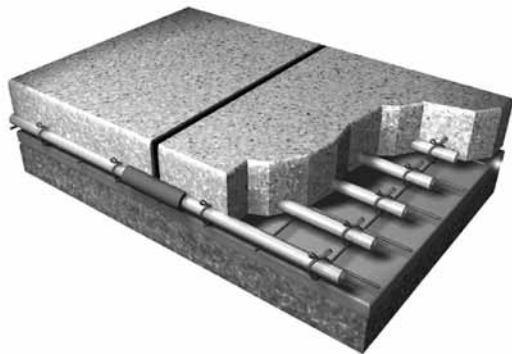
Tuyau recouvert d'isolant près d'un joint de construction
